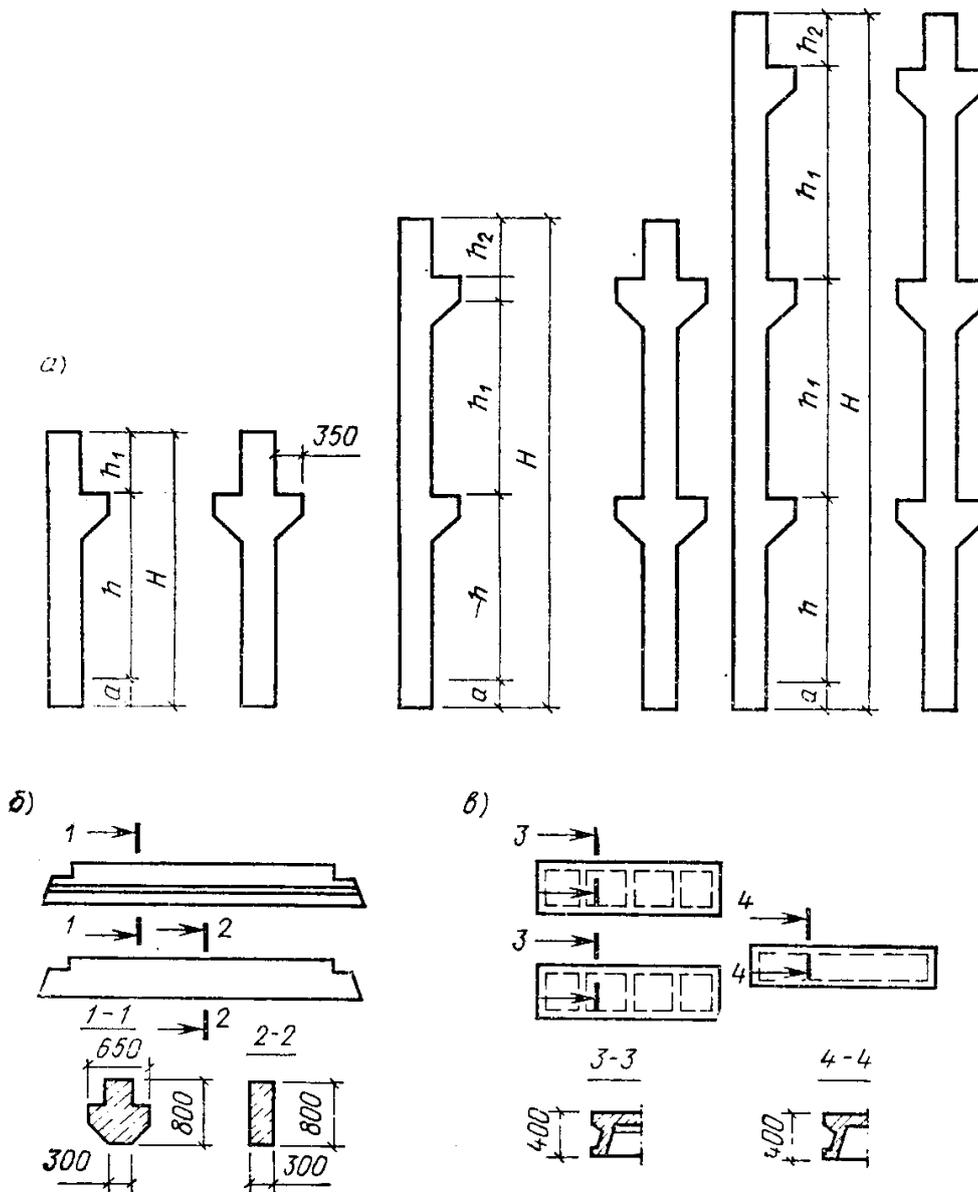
Унифицированные сборные железобетонные элементы многоэтажных промышленных зданий:
